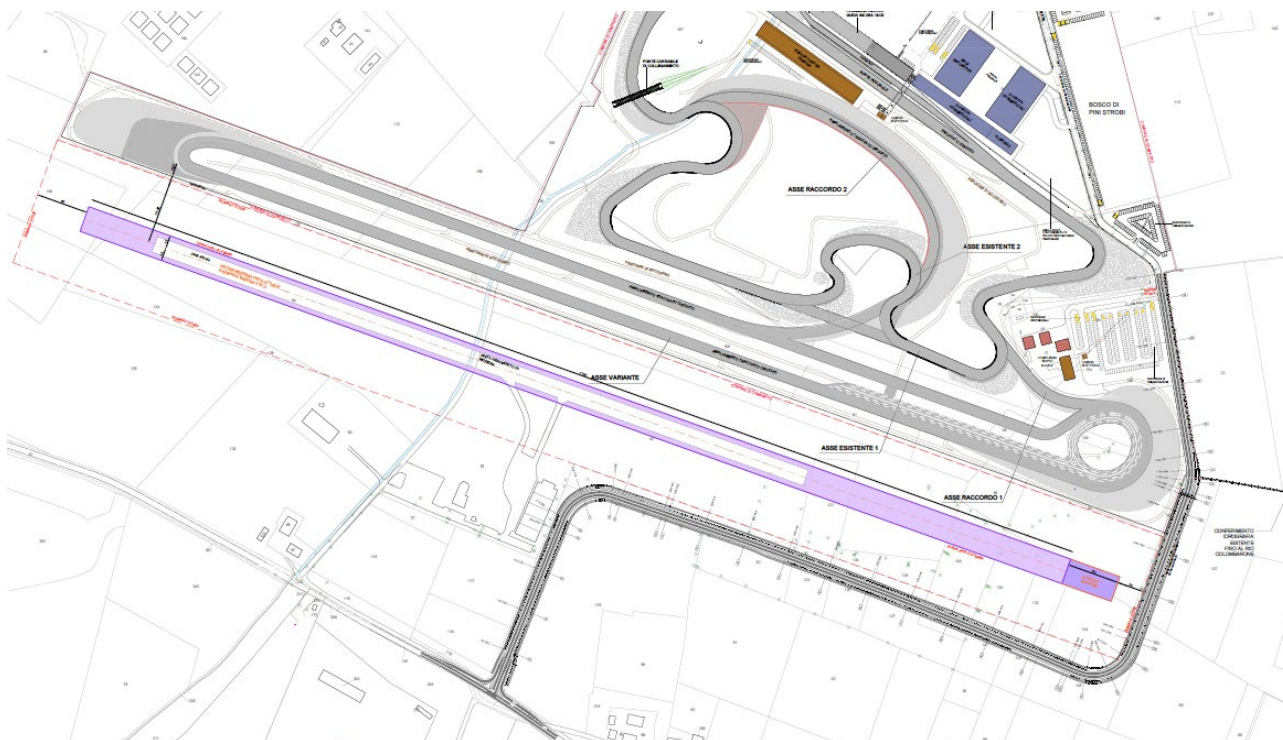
SVILUPPO PLANIMETRICO NUOVA STRADA EXTRACOMPARTO DI ACCESSO ALL'AUTODROMO DI MODENA
